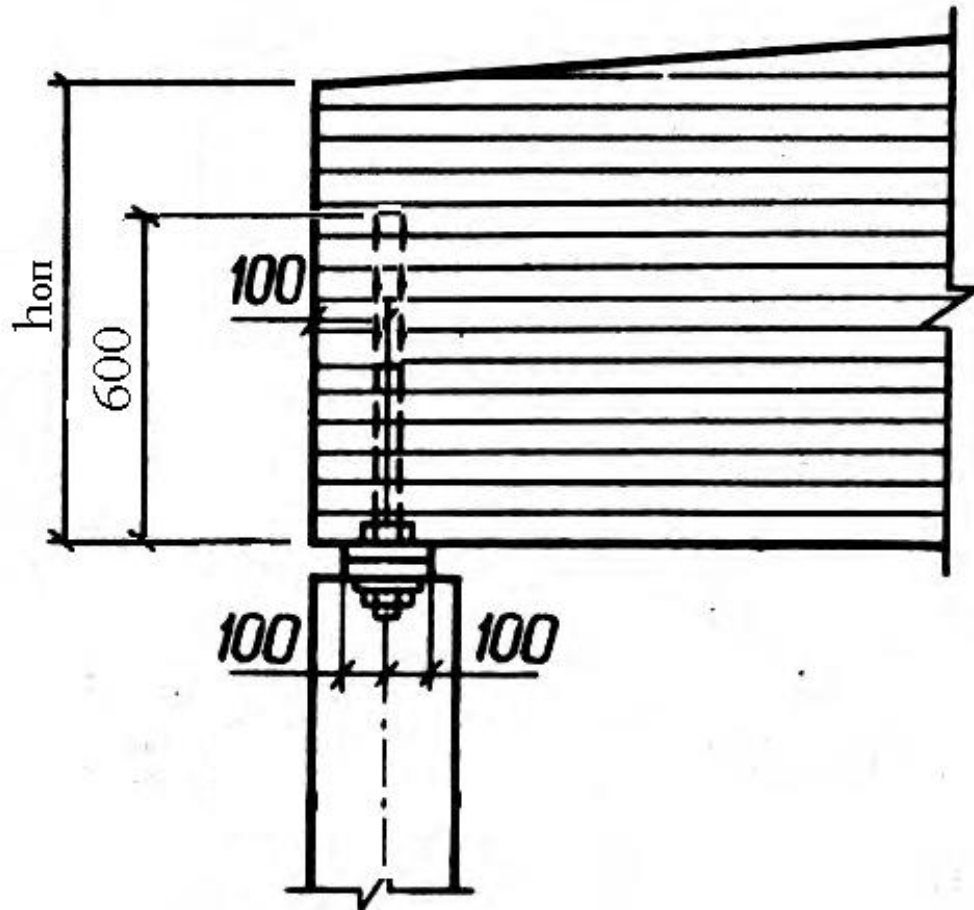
Конструкция опорного узла дощатоклееной балки на вклеенных стержнях
